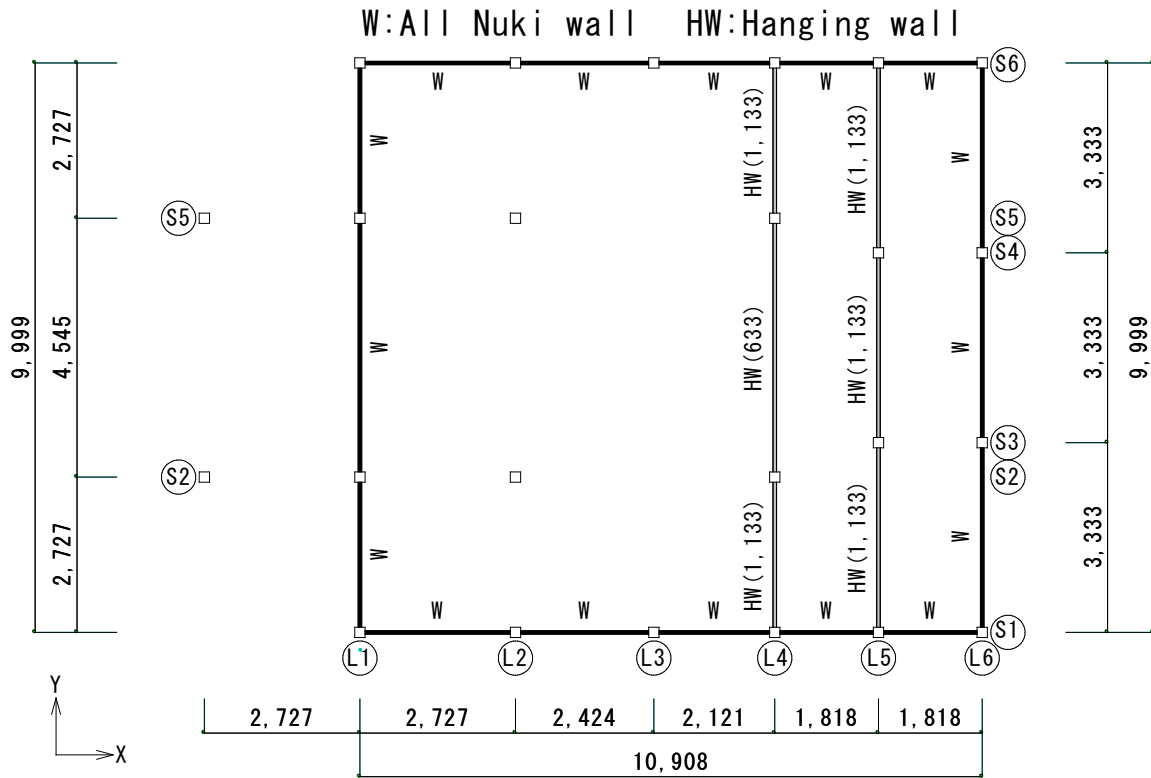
解析モデル平面図 (図 4.3.20 再掲)
